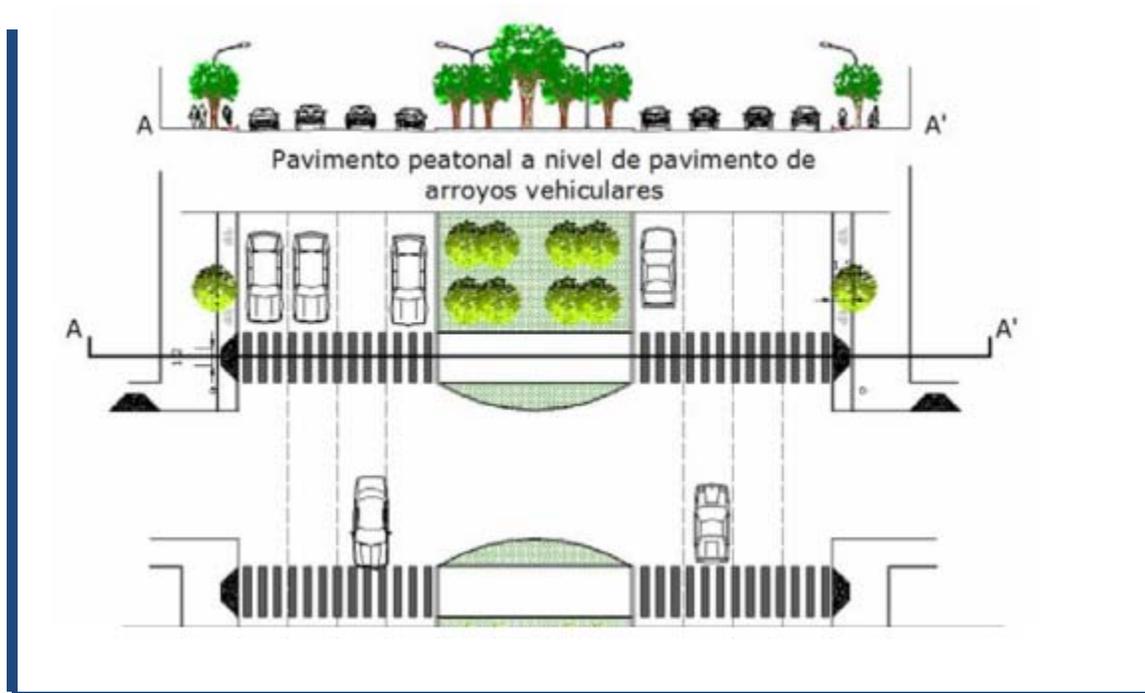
Sección de calle Tipo para el diseño de vialidades donde exista un camellón.
